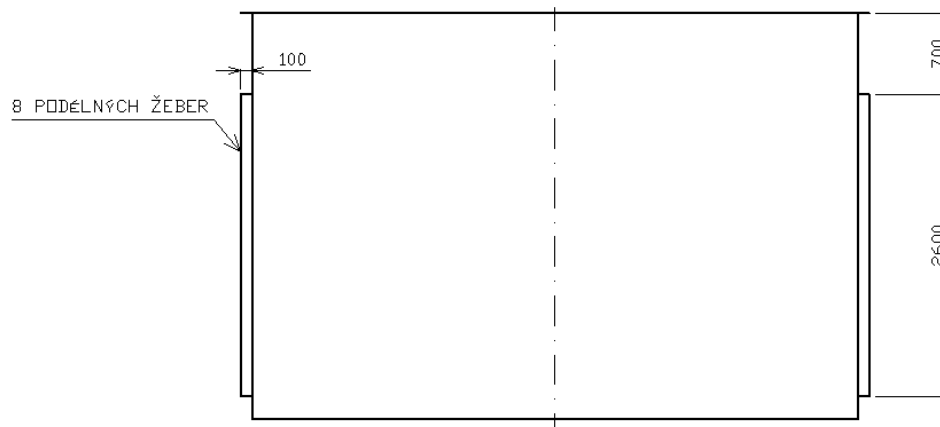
Modifikace pro základní tloušťku stěny 35 mm
